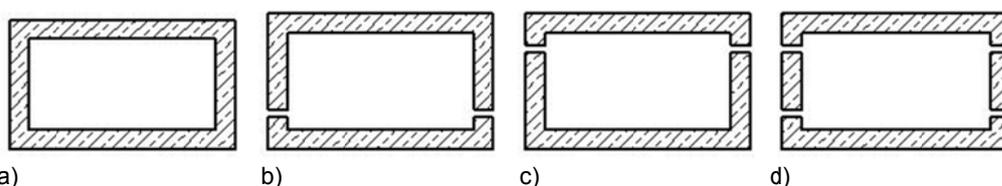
Mögliche Bauweisen bei Tunnelquerschnitten – a) Bauweise ohne Arbeitsfugen;
